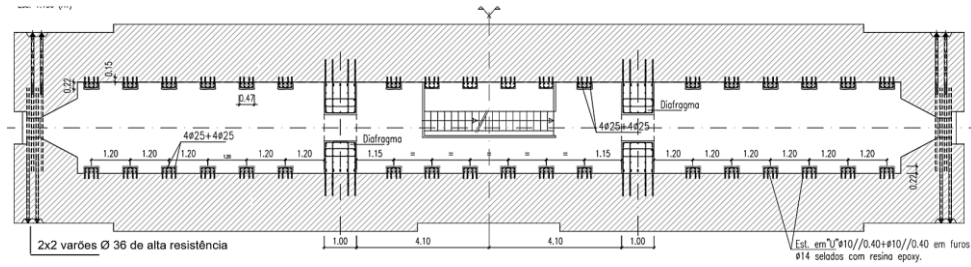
Reforço das pilastras com nervuras armadas, reforço de lintéis e paredes-diafragma.
